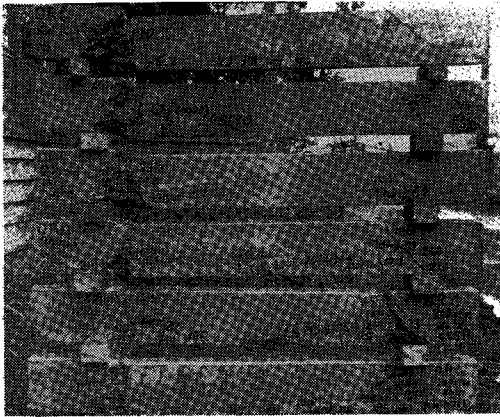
(ロ) 過鉄筋コンクリートばりの左側の破壊様相 (1)
